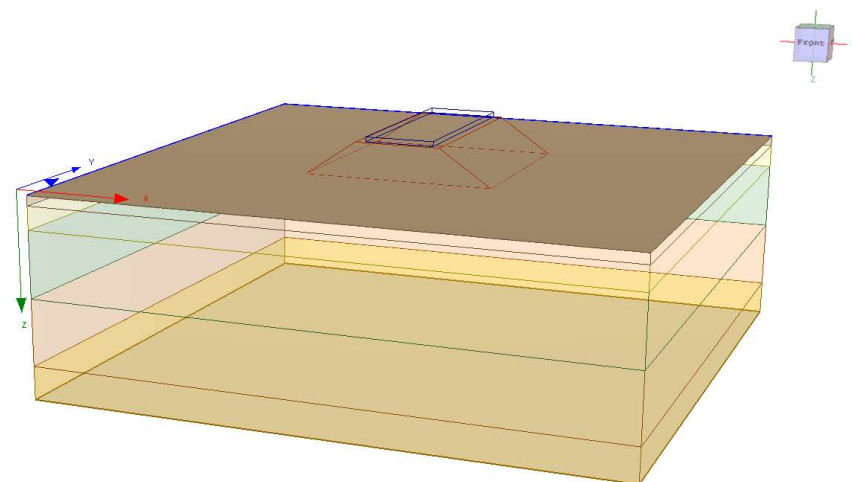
Rilevato sez n° 20 alla pk 26+531,24 - Analisi SLE – Modello di calcolo – Posa Ballast
